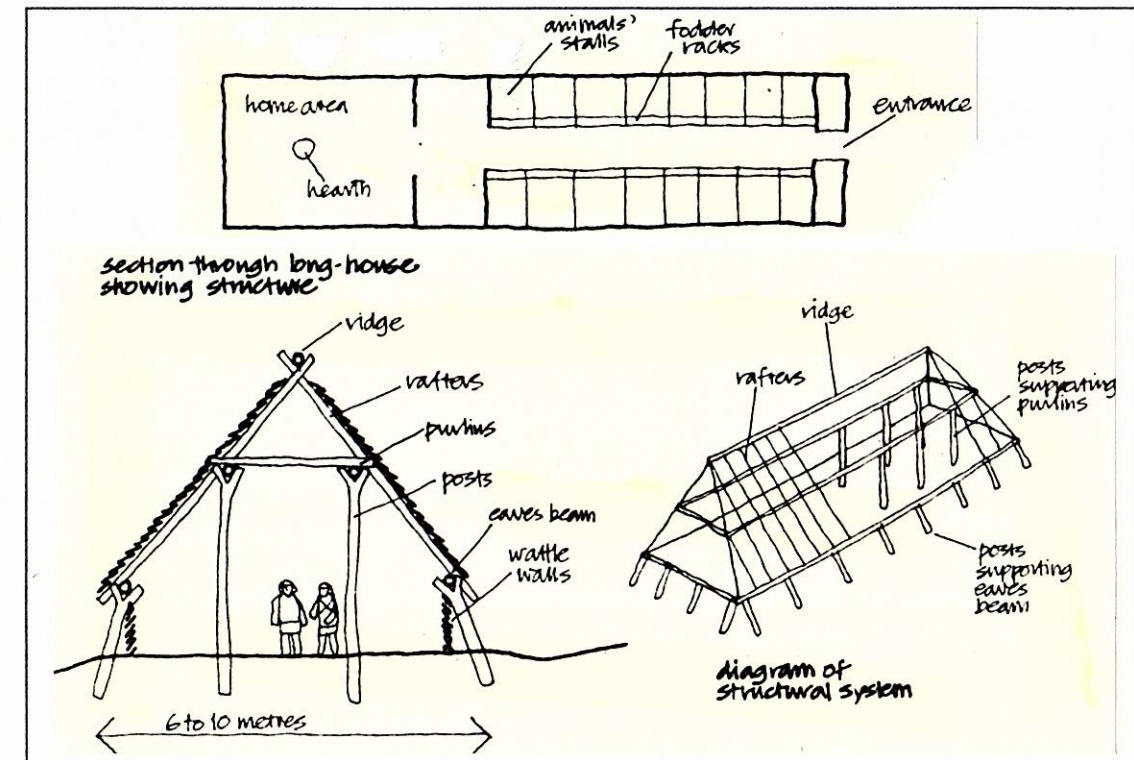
Plan et système constructif d'une habitation allongée à Feddersen, Frise, Hollande (RISEBERO, 41).
